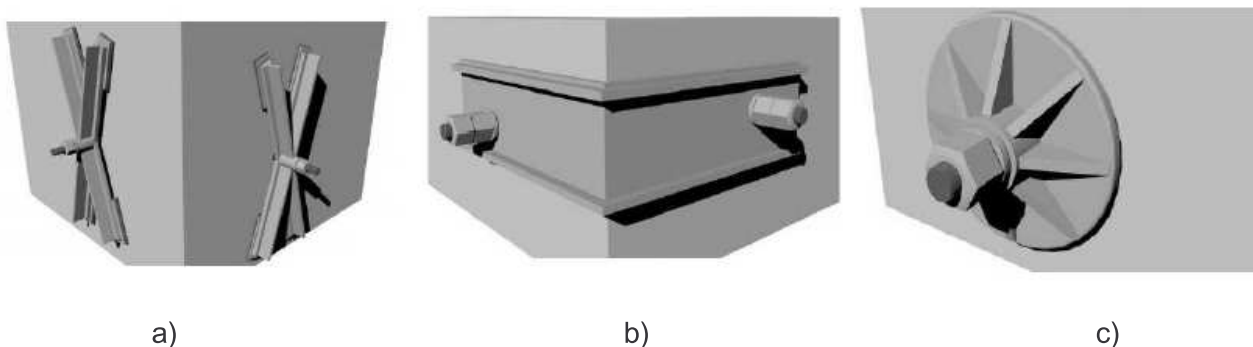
Particolari di capichiave metallici per tiranti: a X con piattine di distribuzione (a); capochiave d'angolo con passaggio interno (b); con piastra circolare flangiata a raggiera (c)
